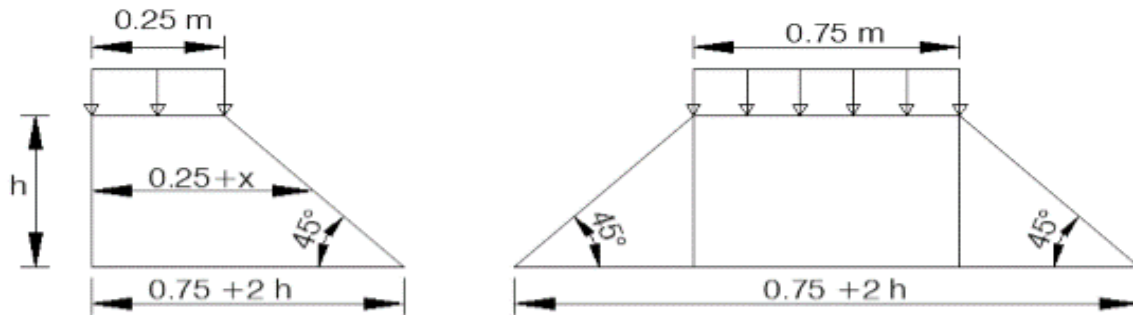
Poussée de la charge locale située en arrière du mur
